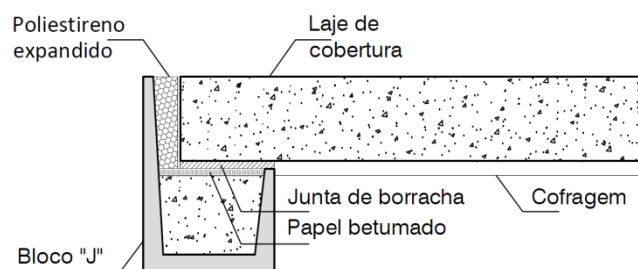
Pormenor de ligação entre a laje de cobertura e o bloco canaleta tipo "J", (adaptado de Accetti, 1998).
